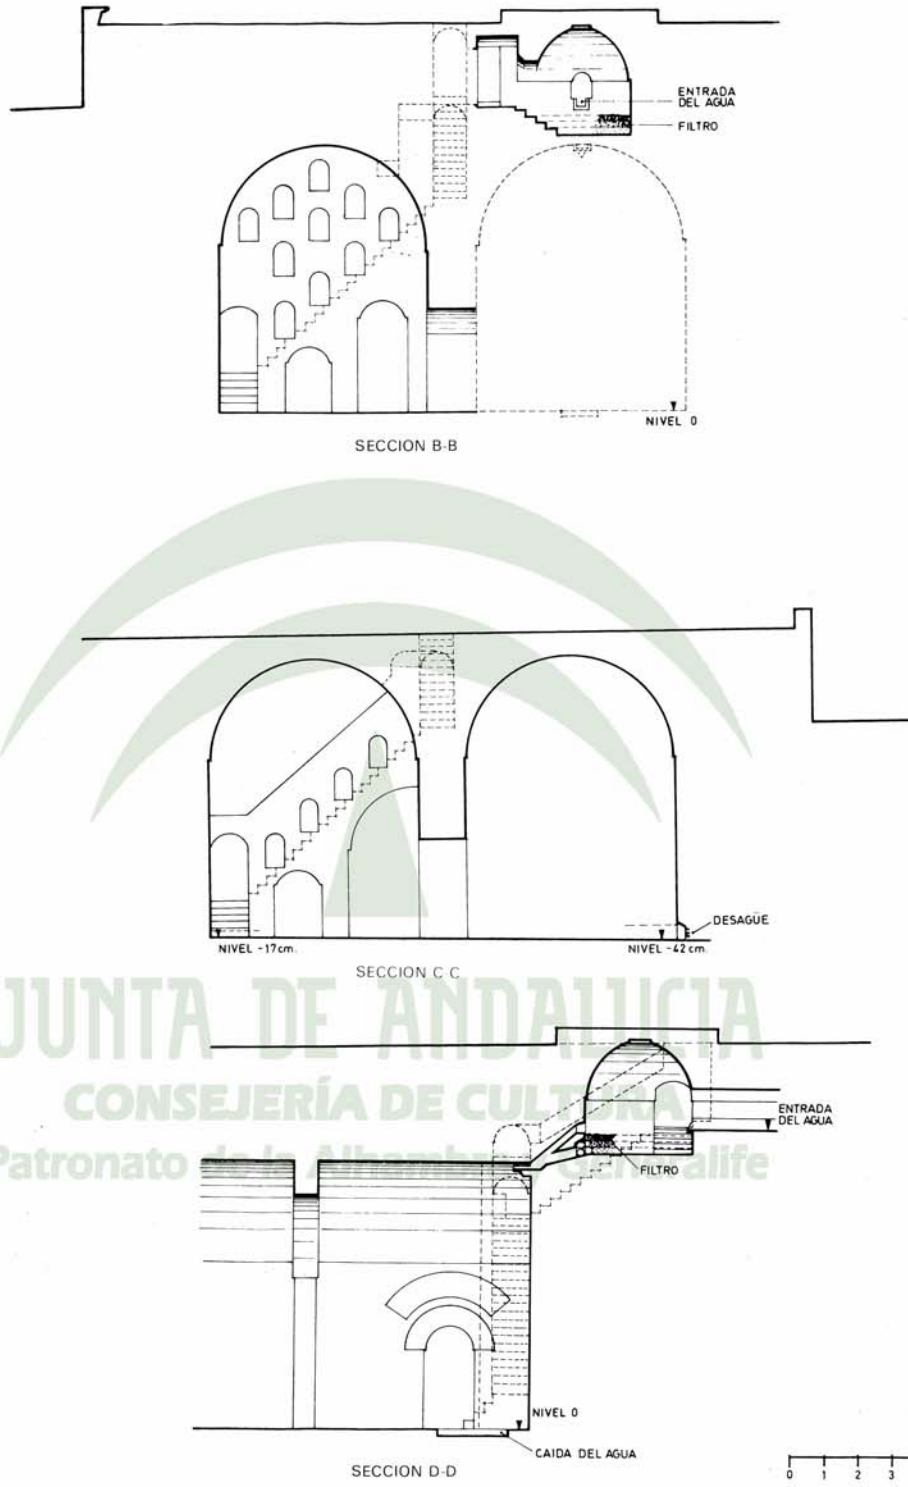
Secciones transversales y detalle de la sección longitudinal.
